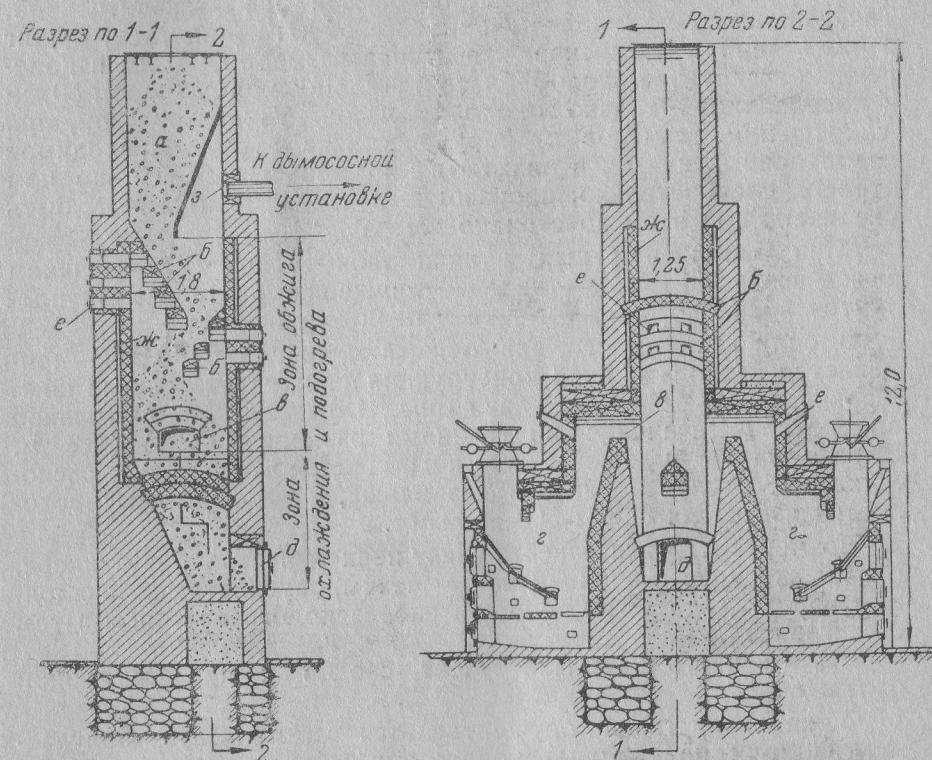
а—бункер для известняка; б—своды для поддержки слоя известняка; в—окна для впуска полугаза в шахту; г—полугазовые топки для дров или торфа; д—окно для выгрузки извести и подачи воздуха в шахту; е—гляделки; ж—футеровка шахты; з—патрубок для отсоса отходящих газов.
